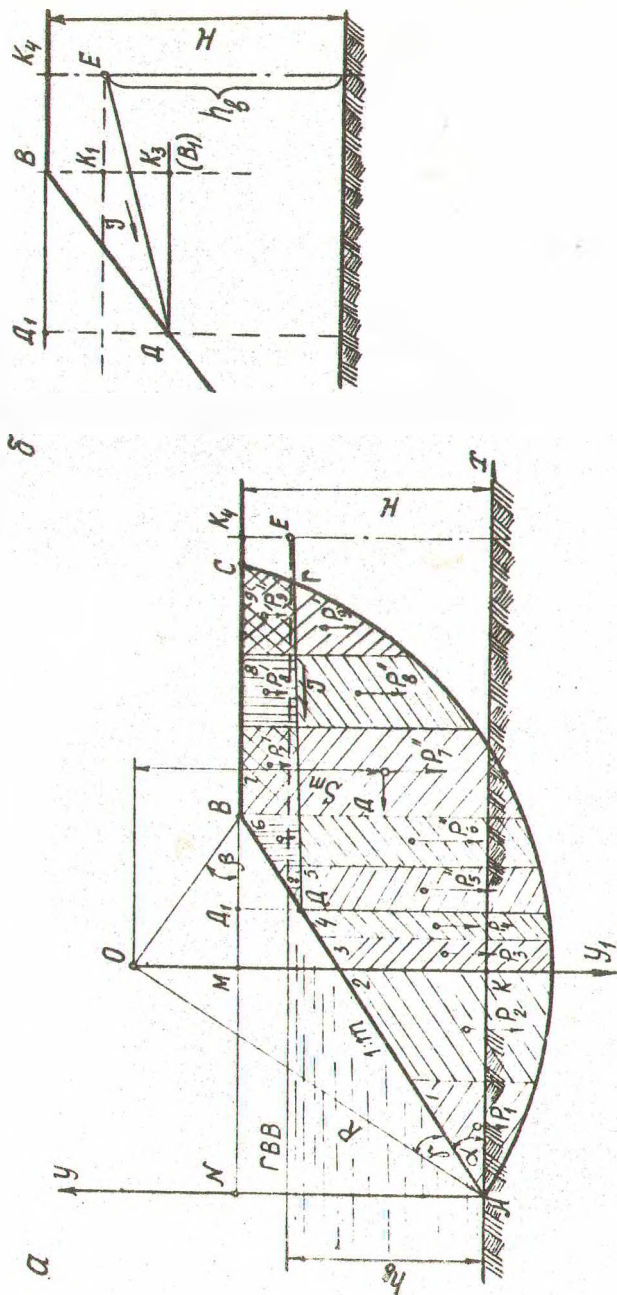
Подтопленная насыпь: а) расчетная схема; б) деталь расчетной стены
